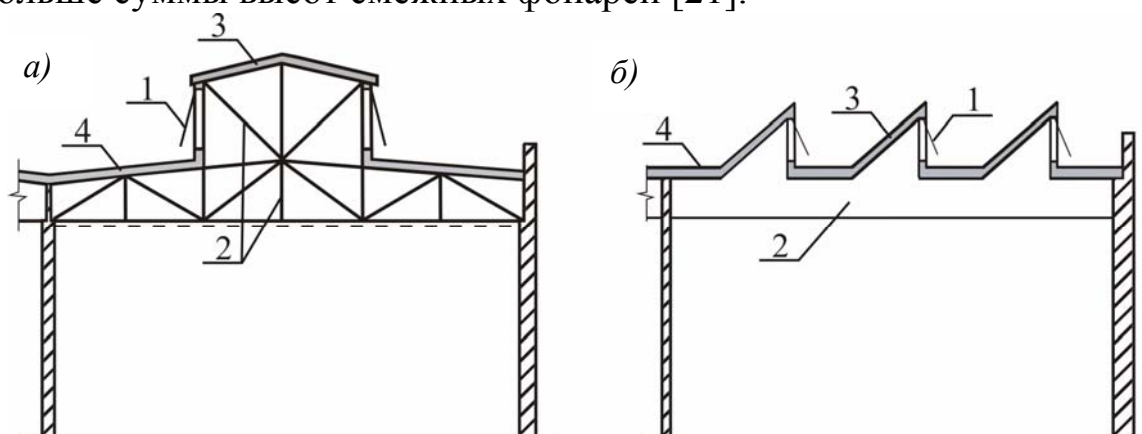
Светоэрационные фонари: а – прямоугольный; б – шедовый; 1 – светопропускающие открывающиеся створки; 2 – несущие конструкции покрытия и фонаря; 3 – ограждающие конструкции фонаря; 4 – ограждающие конструкции покрытия
